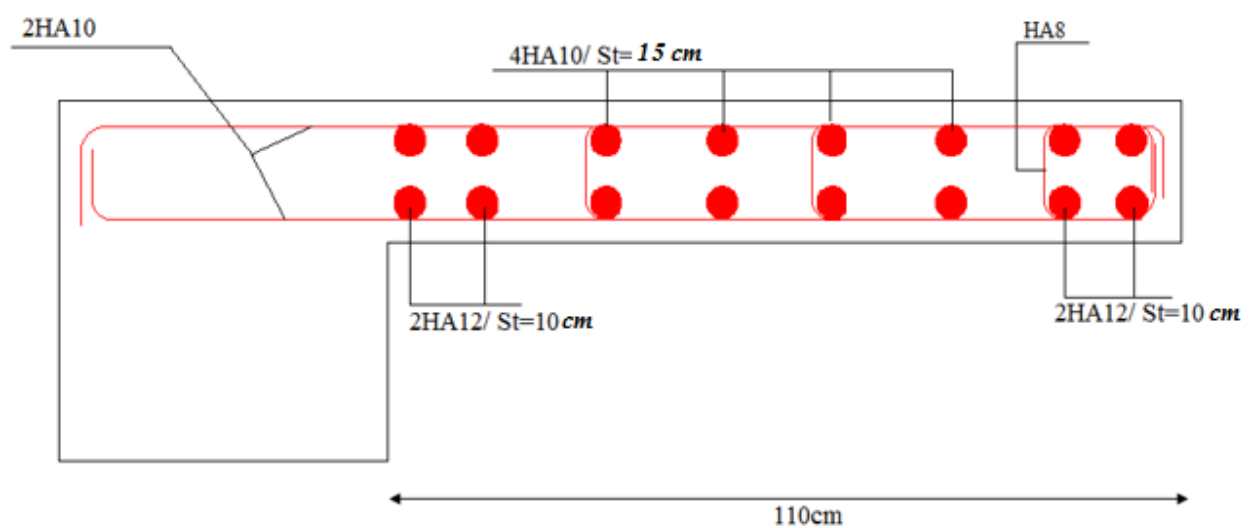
Schéma de ferraillage du voile Vx3. (niveau RDC.)
